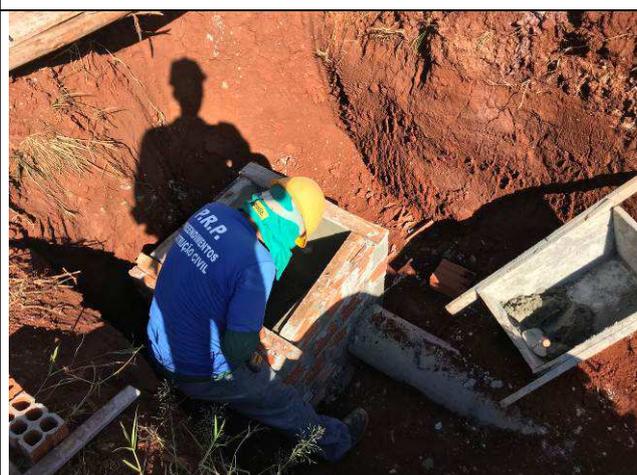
C: Tubos de concreto em caixa de passagem - águas pluviais.
